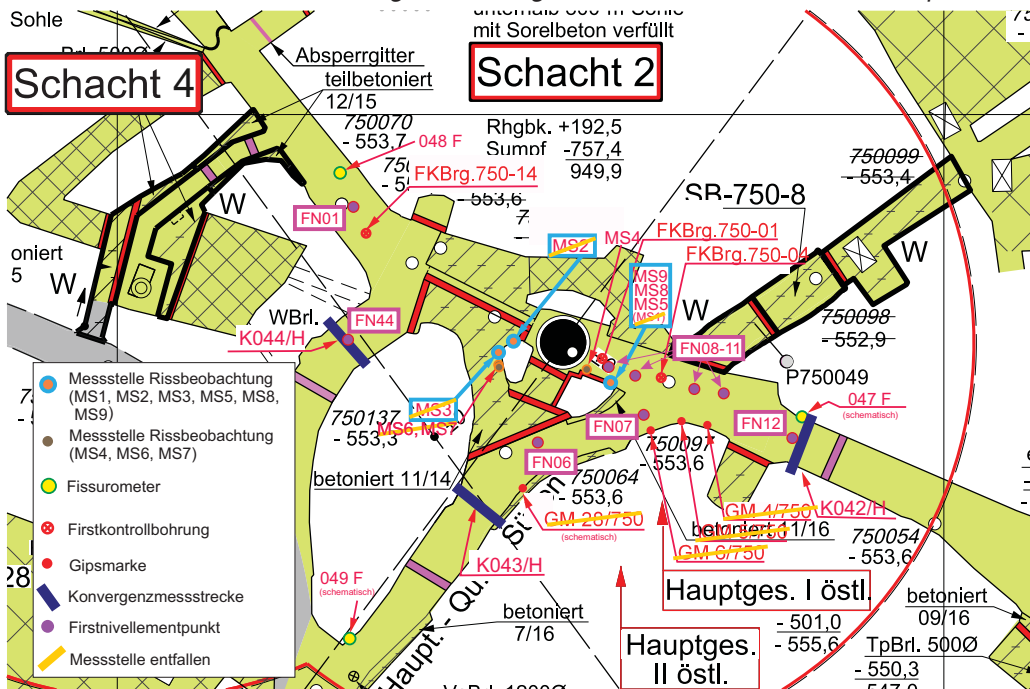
Grundrissausschnitt der 750-m-Sohle der Messbohrungen und -systeme
